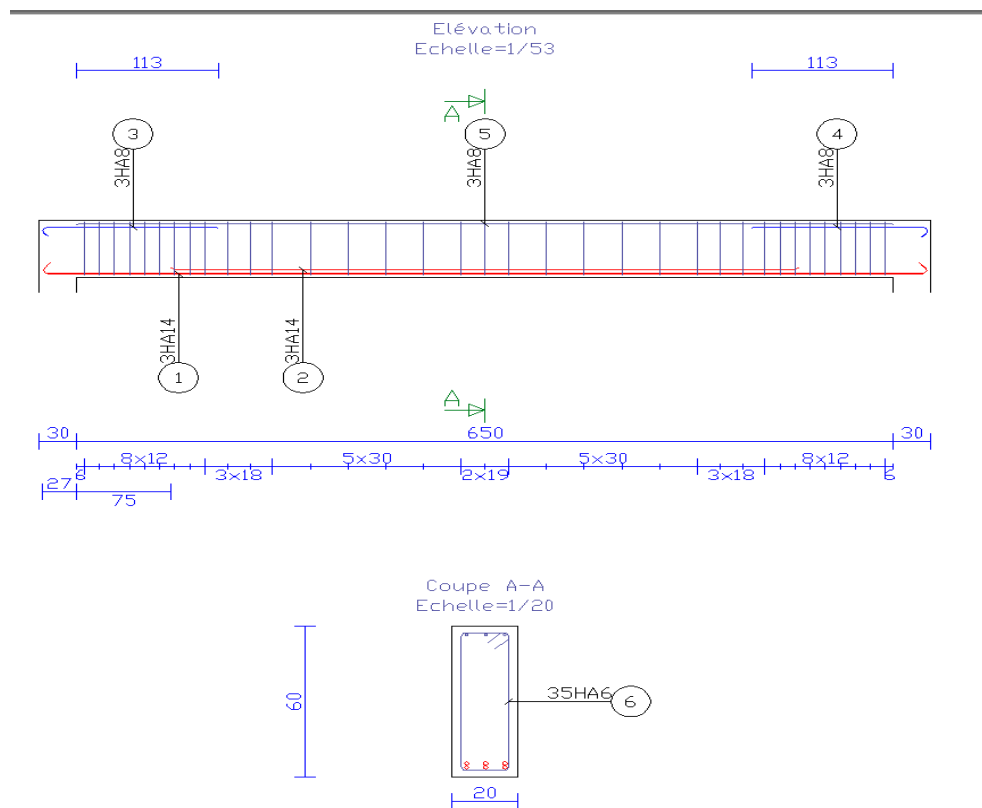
Plan de ferrailage de la poutre en BA
